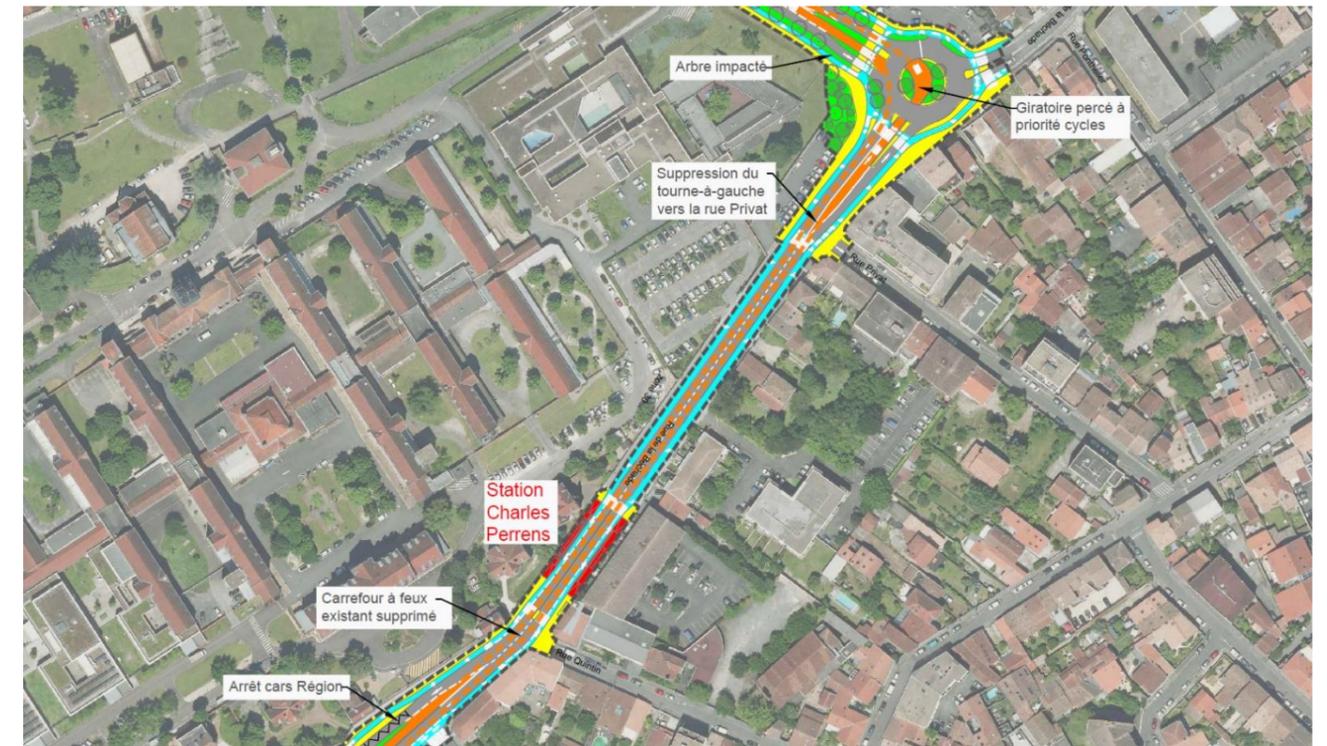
Extrait de plan AVP-Insertion sur la rue de la Béchade
